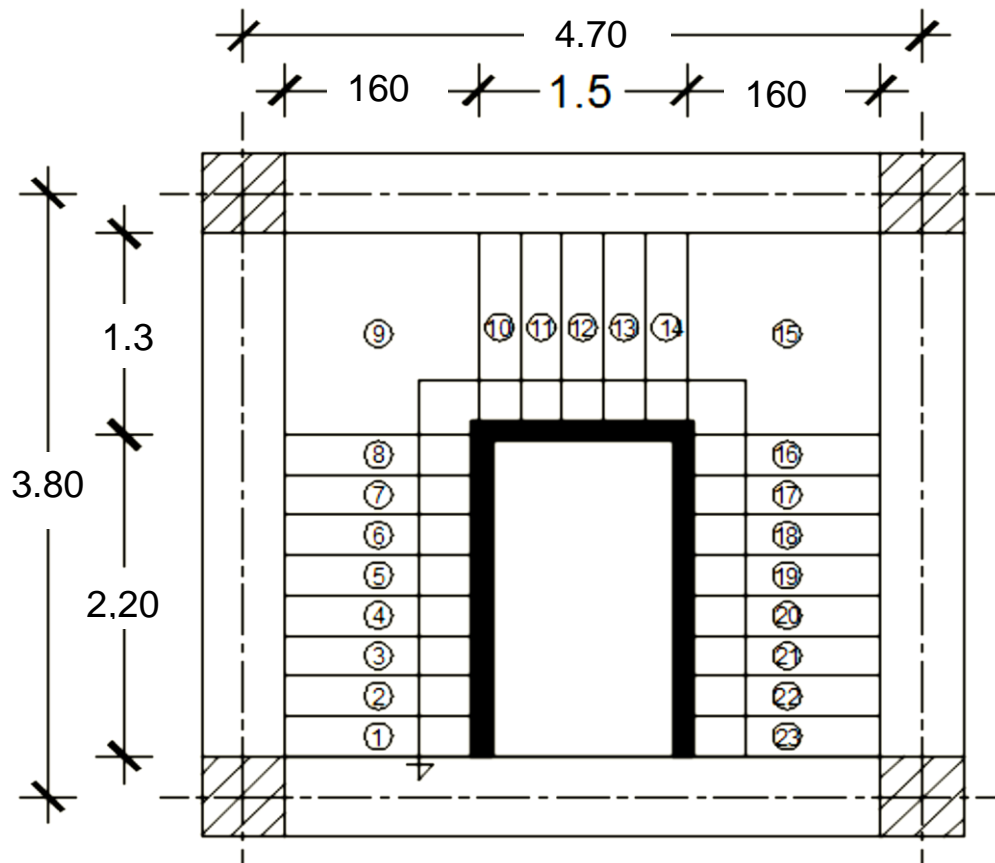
Vue en plan de la cage d'escalier type1.
